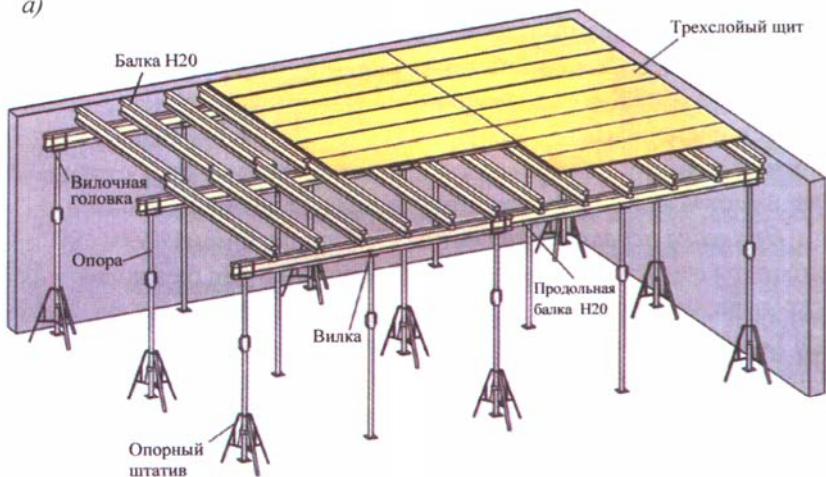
Опалубка перекрытий фирмы «НОЕ» с падающими головками:
